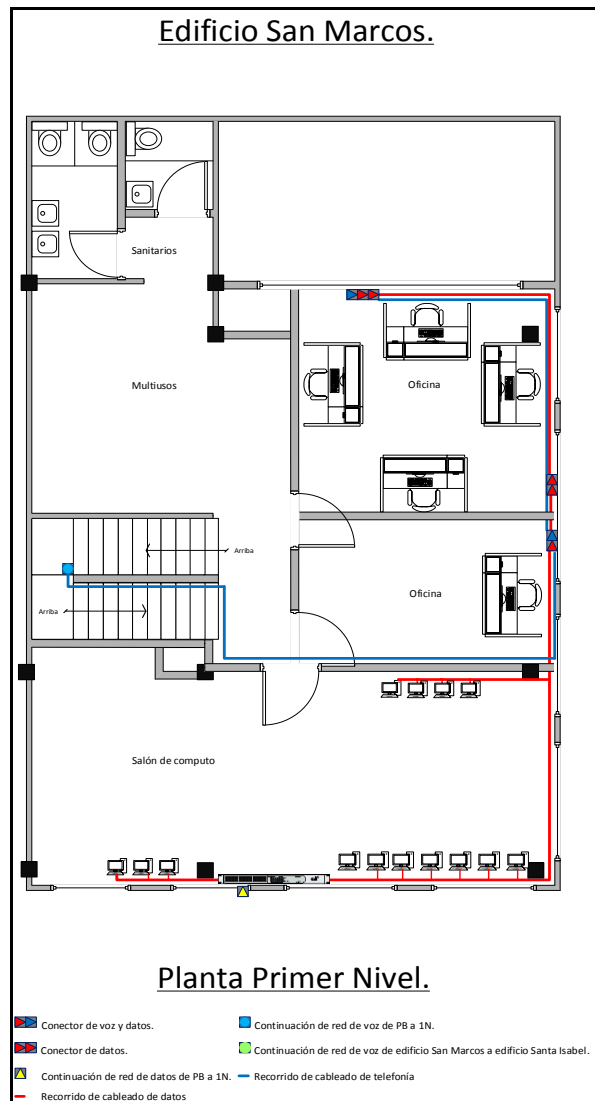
Trayectoria del cableado, edificio San Marcos P1. (Mateos, 2017) Recorrido del cableado en las oficinas y salones del piso 1, desde el switch 3COM hasta las estaciones de trabajo y el punto en el cual el cableado llega proveniente de la planta baja.
